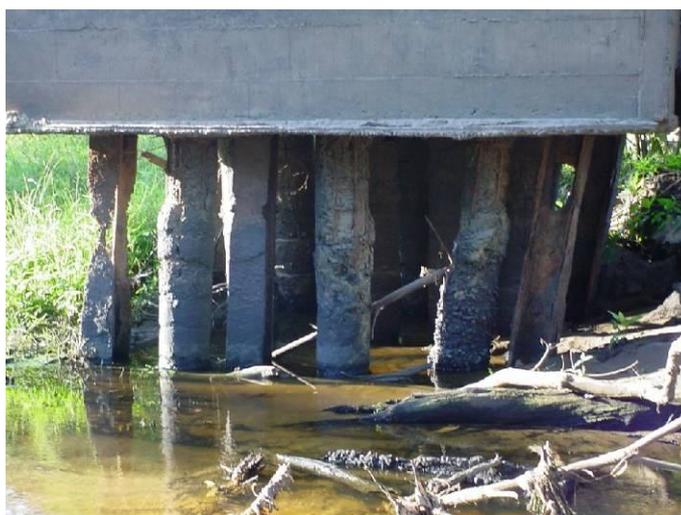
Situação das estacas de fundação da ponte, caracterizando a falta de confinamento lateral. (Fonte: VITÓRIO, 2008).
